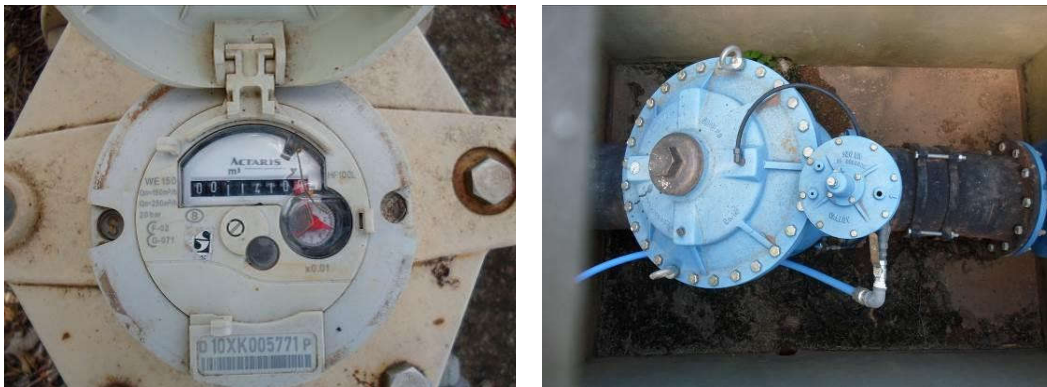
Conjunto de VRP's instaladas na rede de distribuição do SAA.
